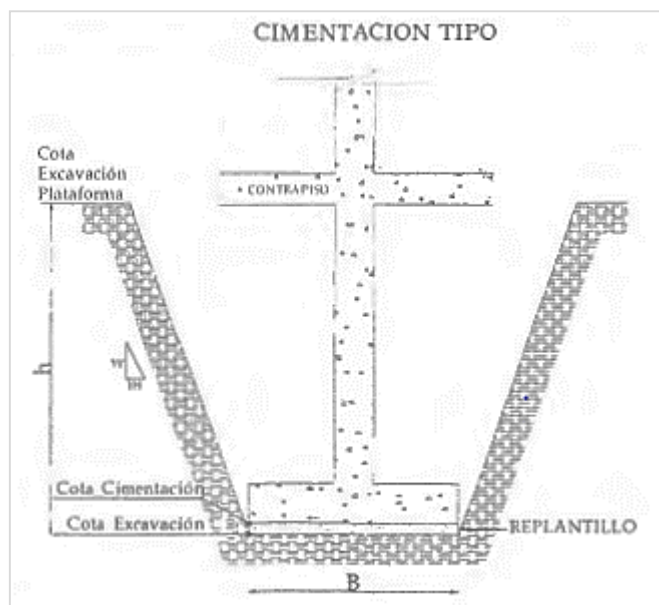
Cimentación tipo zapata aislada Vivienda tipo C41-P9
